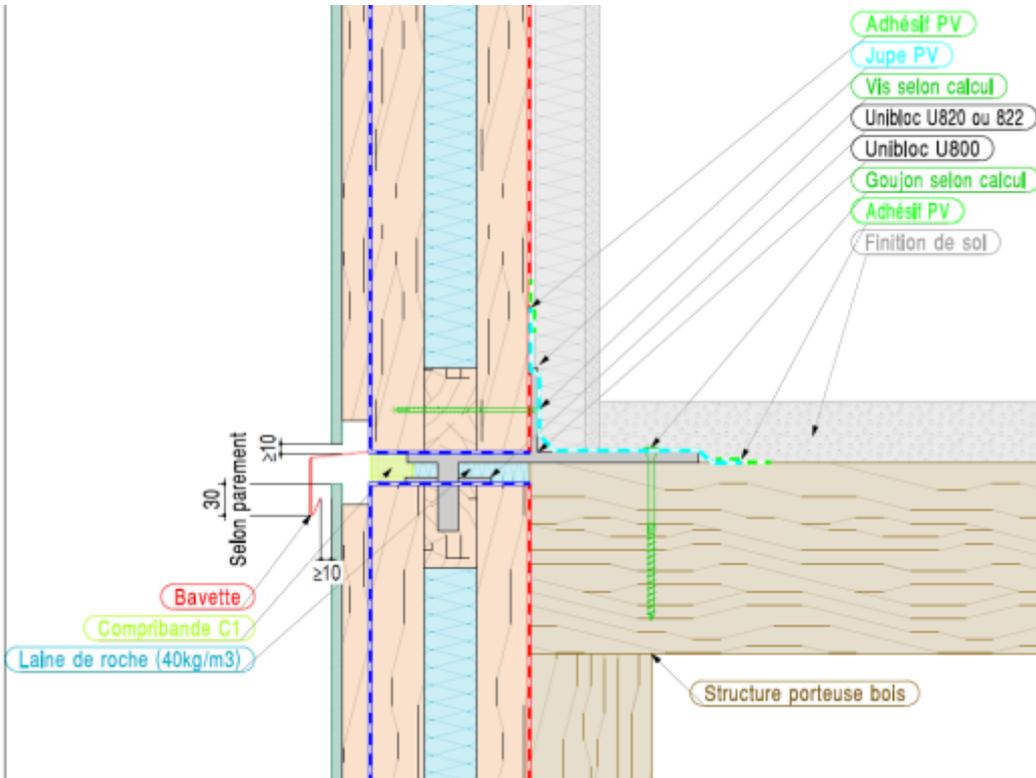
Raccord de panneaux en nez de dalle de structure porteuse en bois (poteau-poutre)
